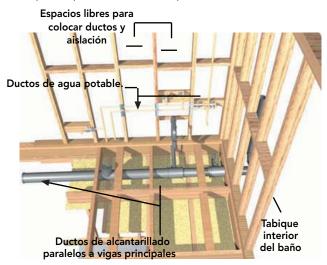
Colocación de ductos de alcantarillado y agua potable en los espacios que generan las estructuras de madera.
